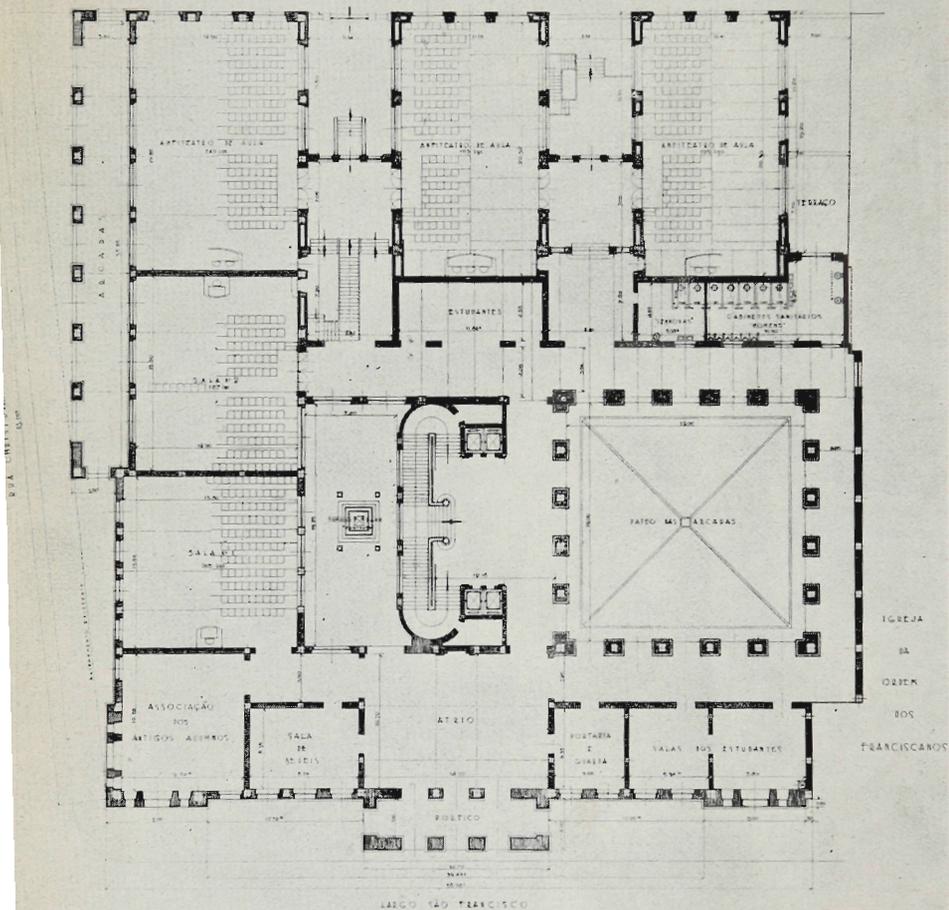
Planta do novo edificio — 1.º pavimento.
